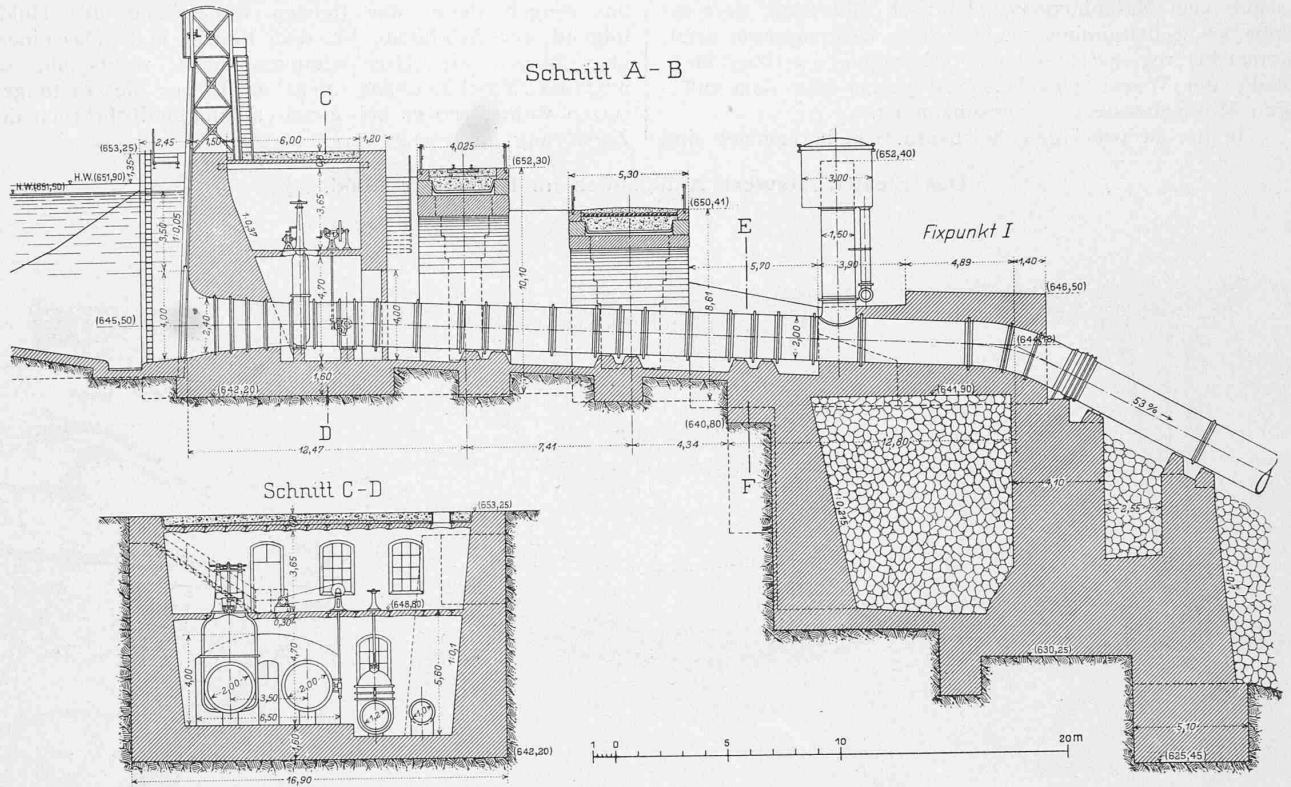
und 19. Grundriss und Schnitte A-B und C-D. Masstab 1 : 300.
